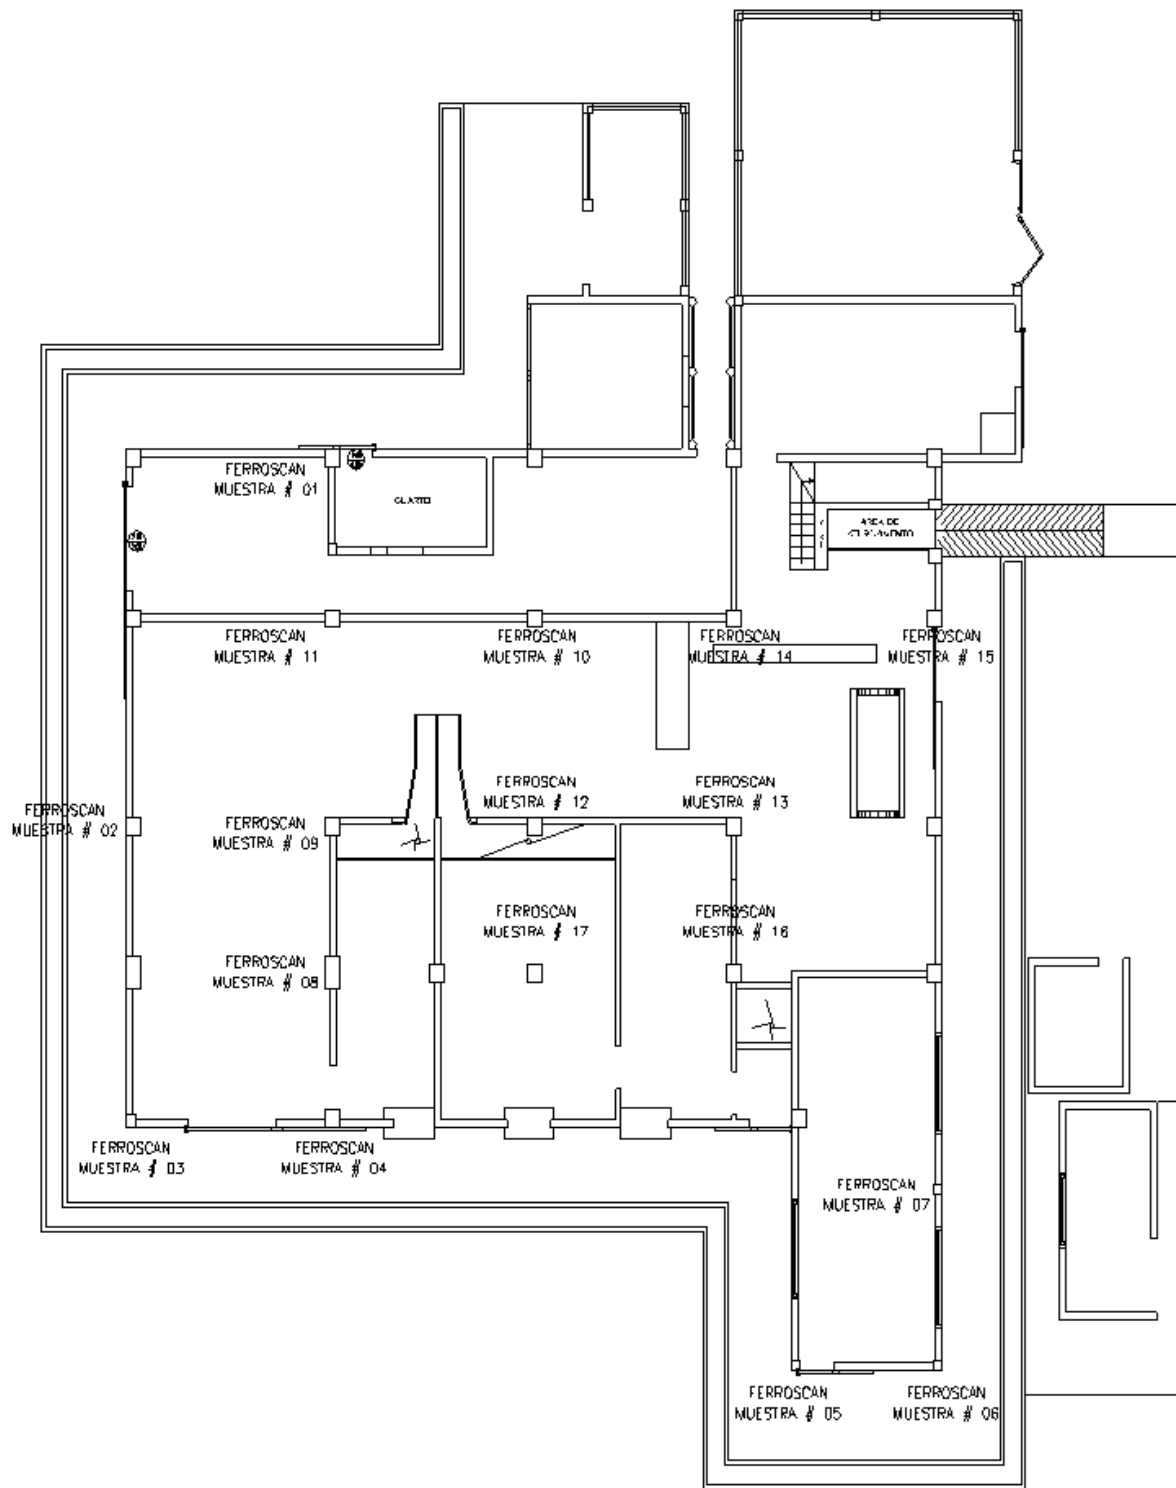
Planta de localización de puntos scanner de aceros. Fuente: Elaboración del autor.
